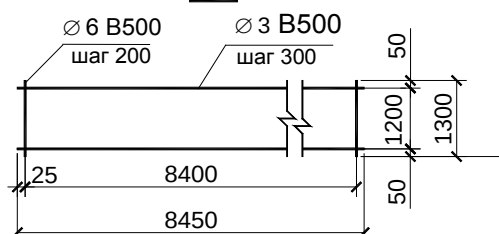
Арматурные сетки для плиты монолитного перекрытия
